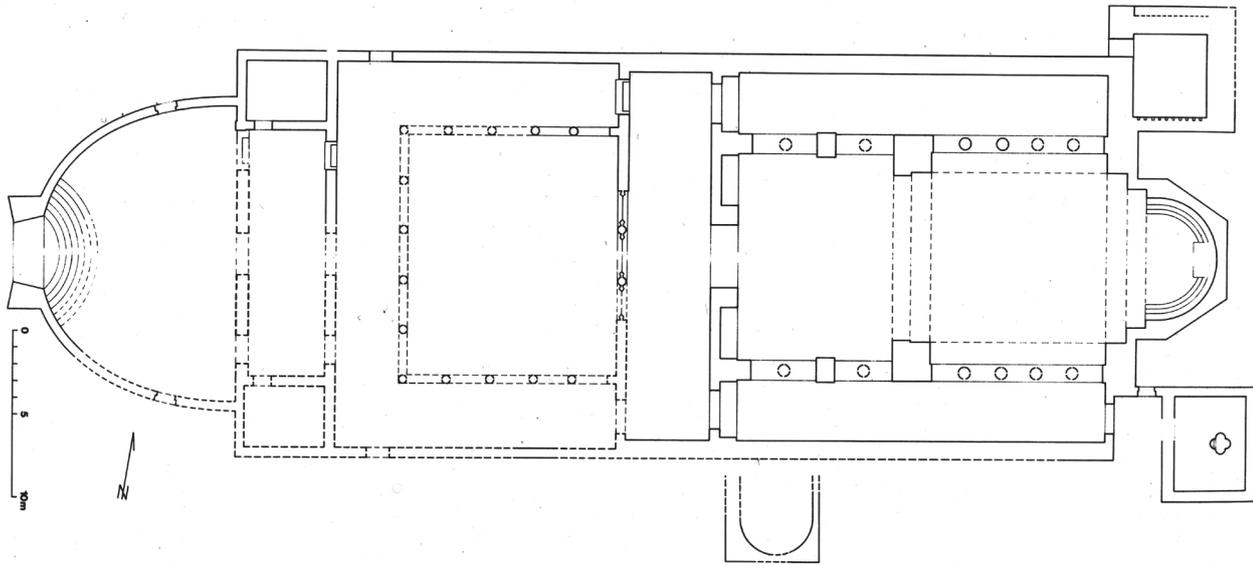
Meryemlik/Isaurien, Grundriss der »Kuppelkirche« (Zenon-Kirche). – (Nach Hellenkemper, Kirchenstiftung Abb. 6).
